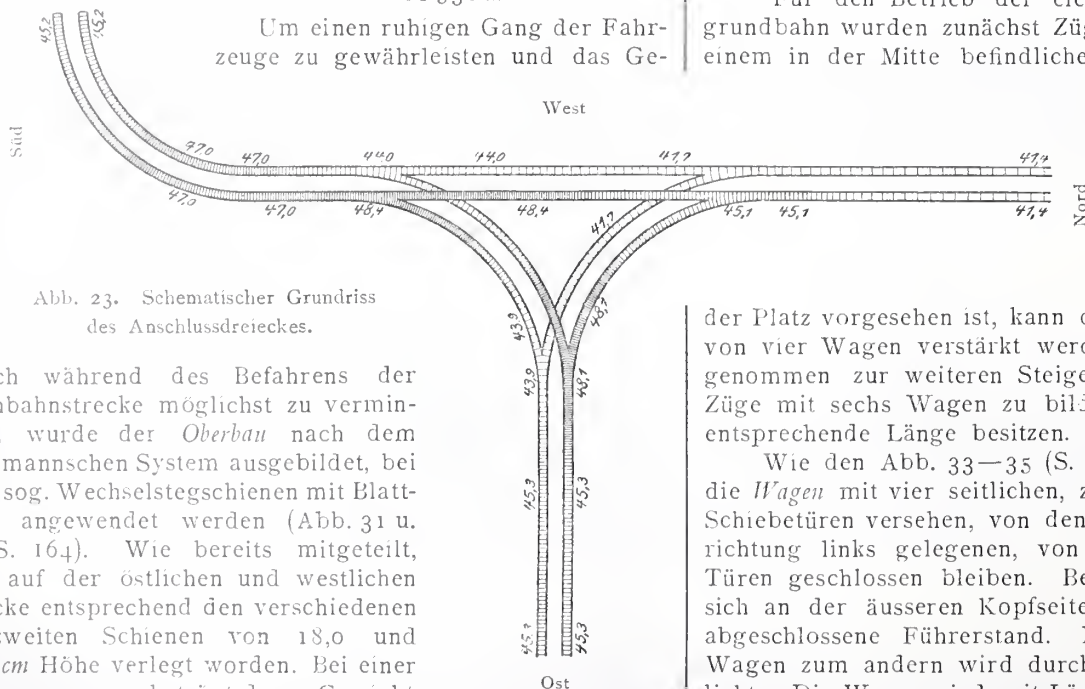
Schematischer Grundriss des Anschlussdreieckes.
